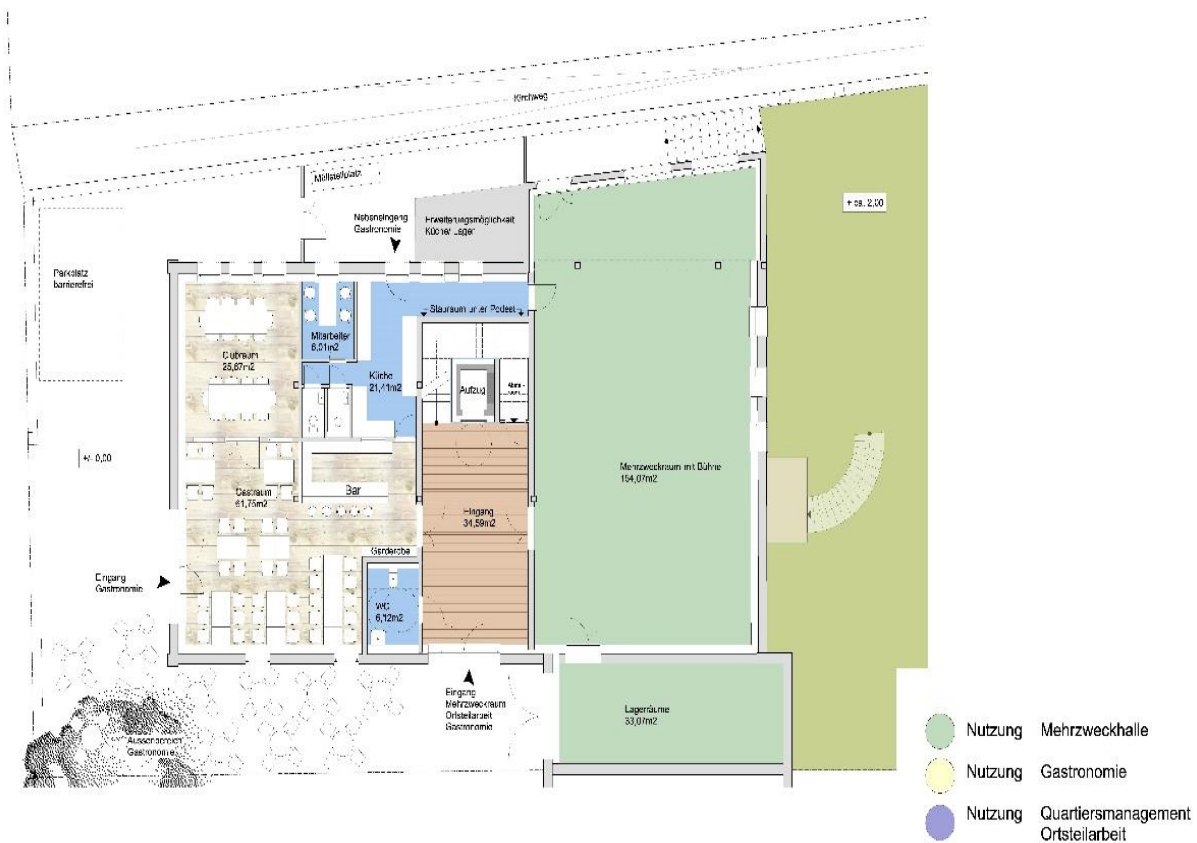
Zukünftige Raumaufteilung im Erdgeschoss, Mehrzweckhalle mit Gastronomie.
